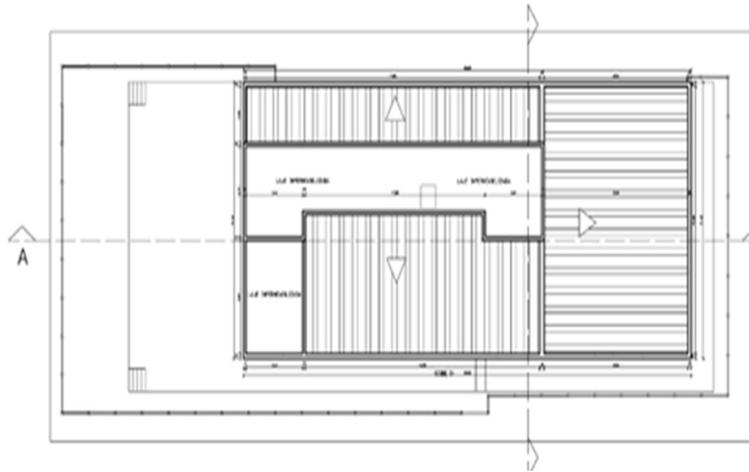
Planta Baixa do Fórum Paula Batista. Fonte: TJPE (2021).
